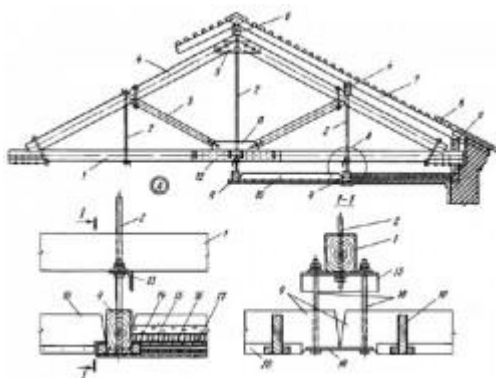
Металл о деревянная ферма с подвесным чердачным перекрытием: 1
